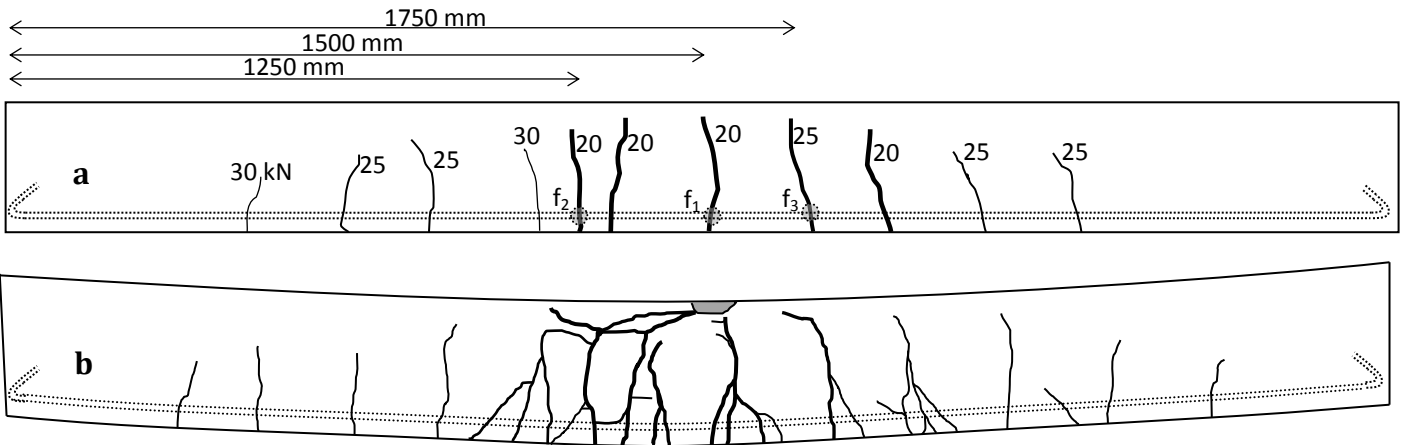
Carte de fissuration de la poutre Y105-0 (a) à l'endommagement (29.5 kN.m), (b) à la ruine.
